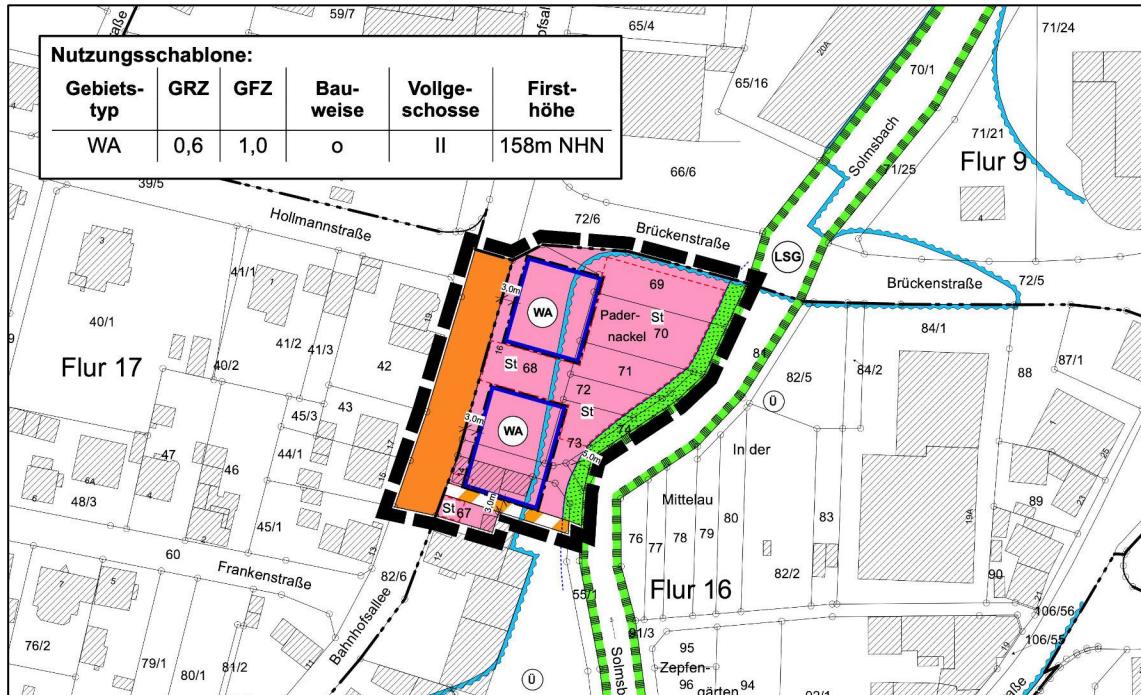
Bebauungsplan – Planteil (unmaßstäblich)
